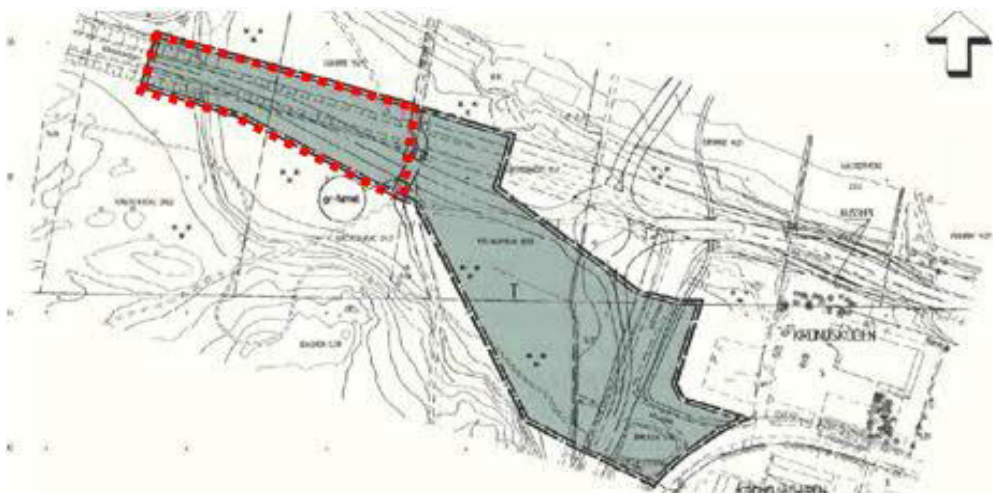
Förslag till stadsplan för Nordvästra Backen
